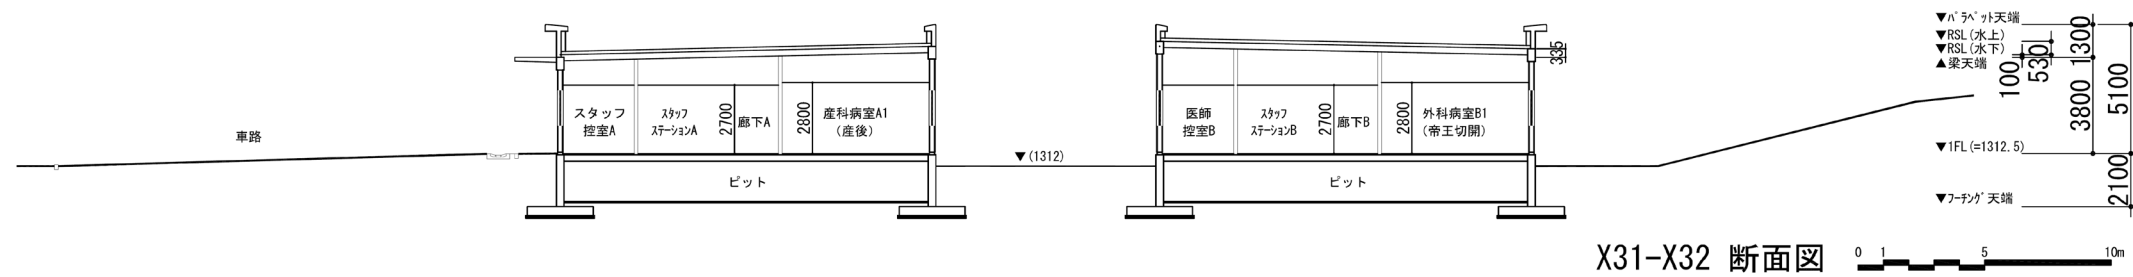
： ムシリー次レベル病院 断面図-1 1/300
